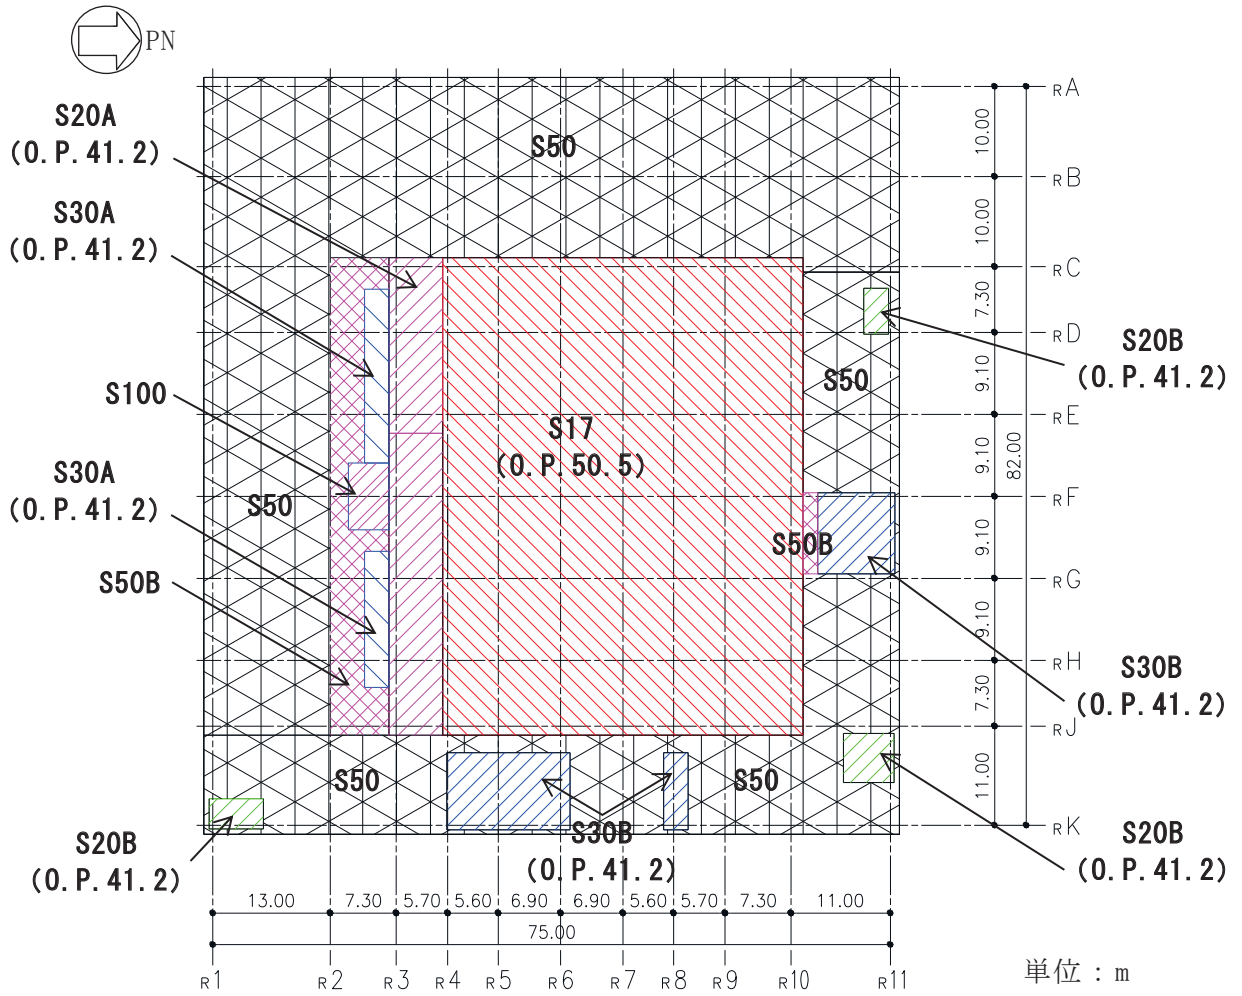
原子炉建屋 屋根スラブの位置図 (O.P. 33.2)
